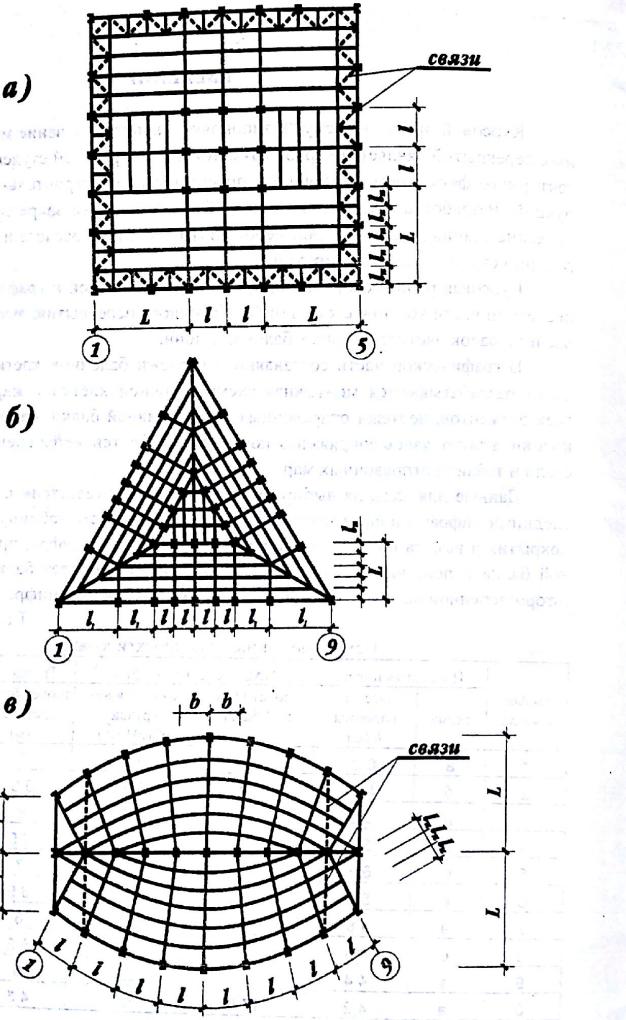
Компоновочные схемы междуэтажных перекрытий
